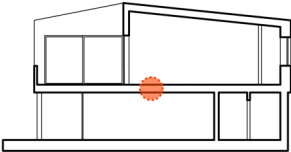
Deckenkonstruktion | Variante 03 | M 1:10
